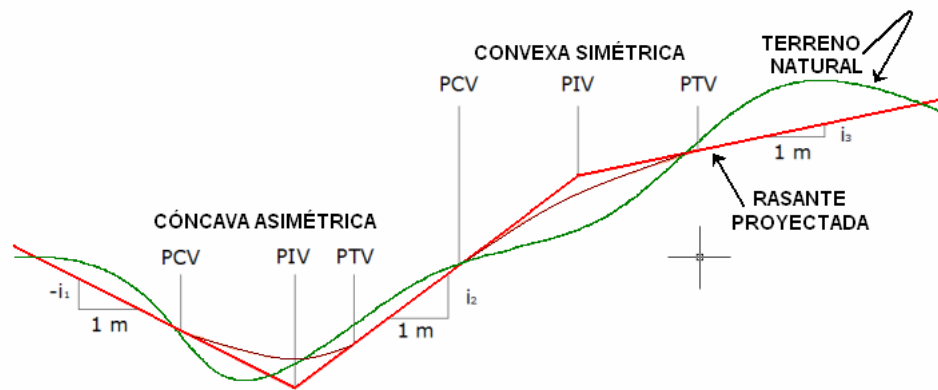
Perfil longitudinal del alineamiento vertical.
